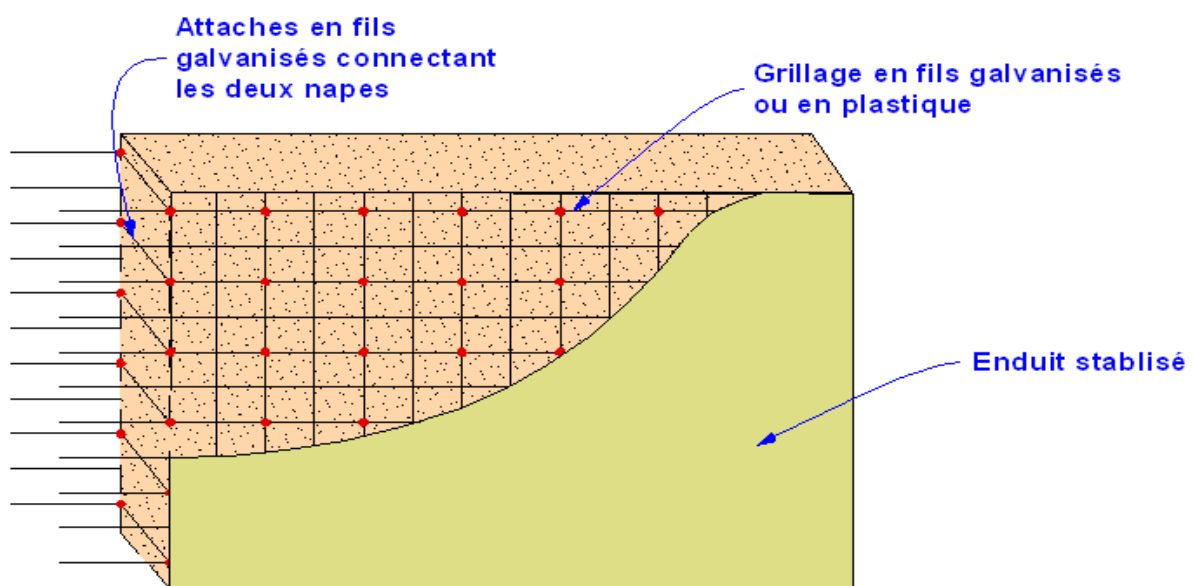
Renforcement latéral des murs par deux nappes en grillage
